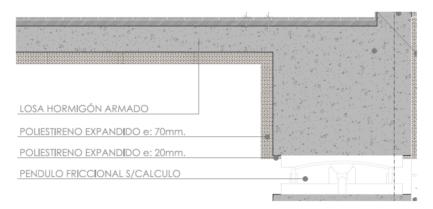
Detalle constructivo de radier Fiscalía Local Talcahuano
